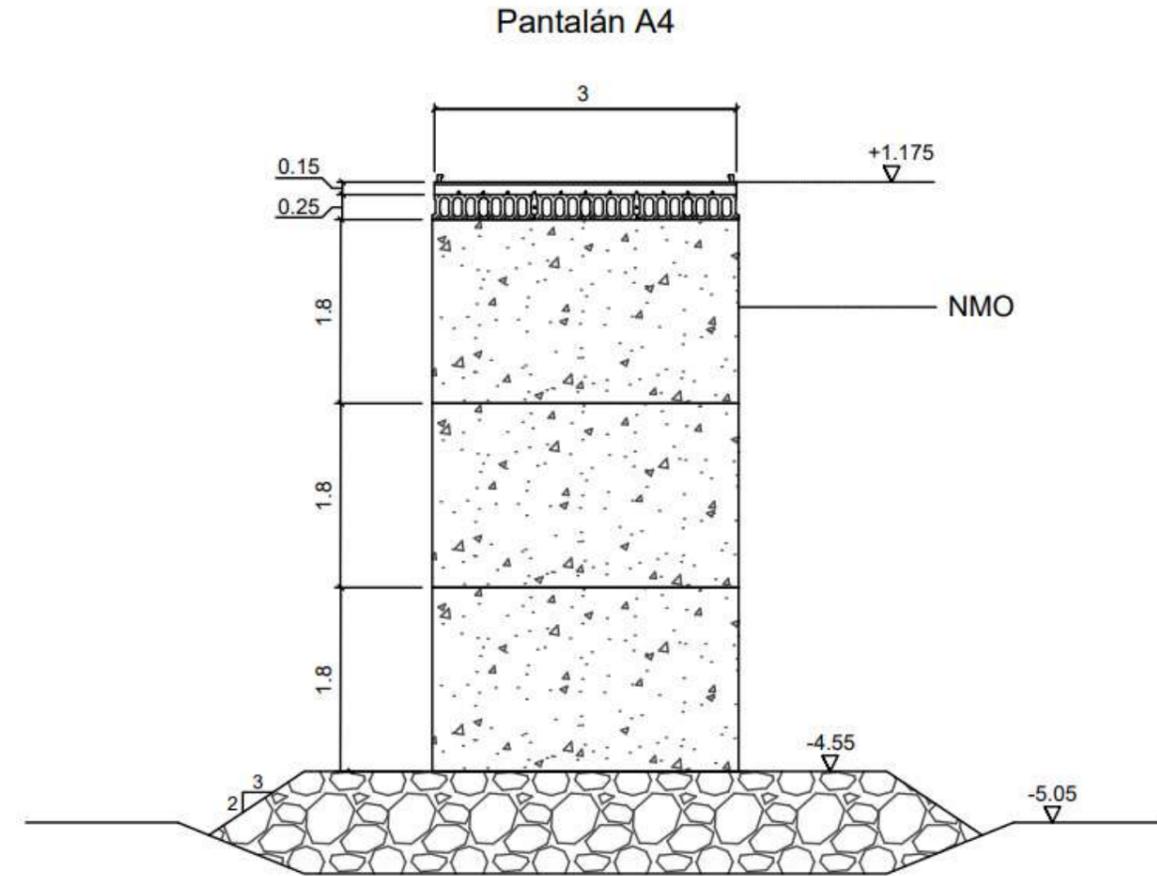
Sección transversal pilas pantalán A4. Fuente: Elaboración propia.
